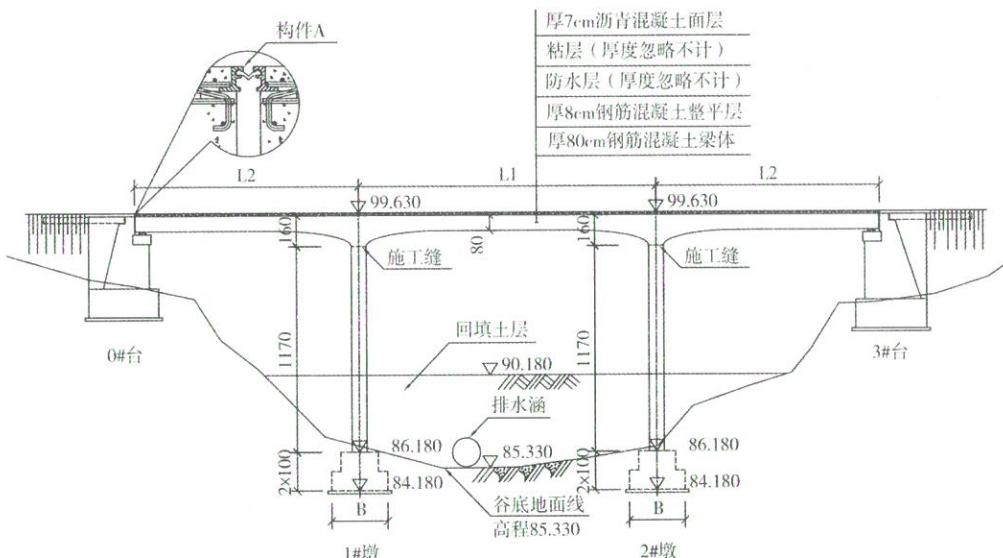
桥梁立面布置示意图 (高程单位: m; 尺寸单位: cm)
